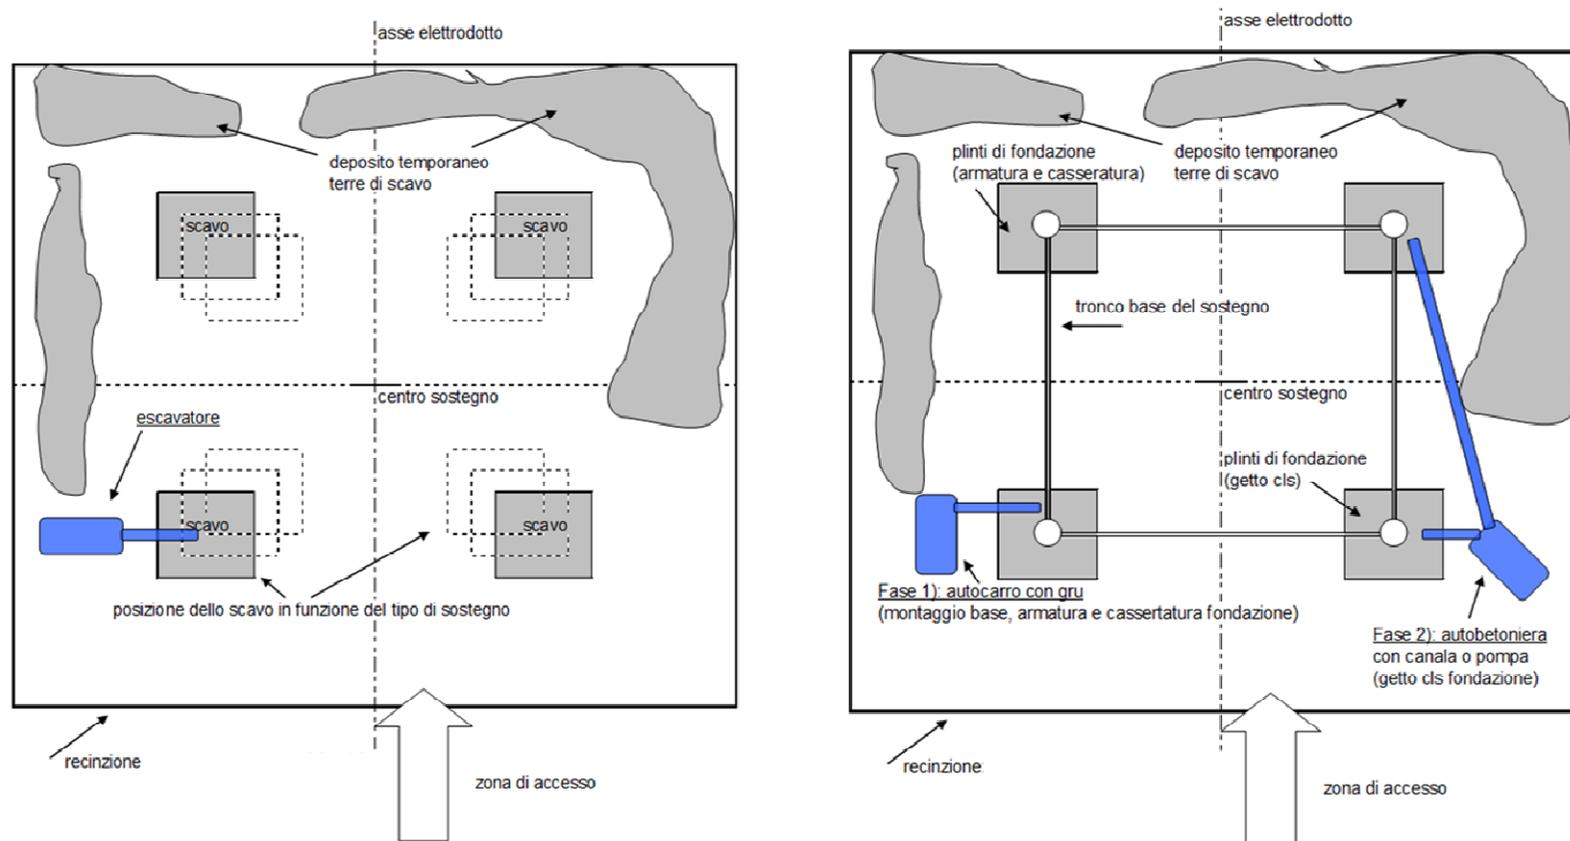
Planimetria dell'Area Sostegno - Tipologico
